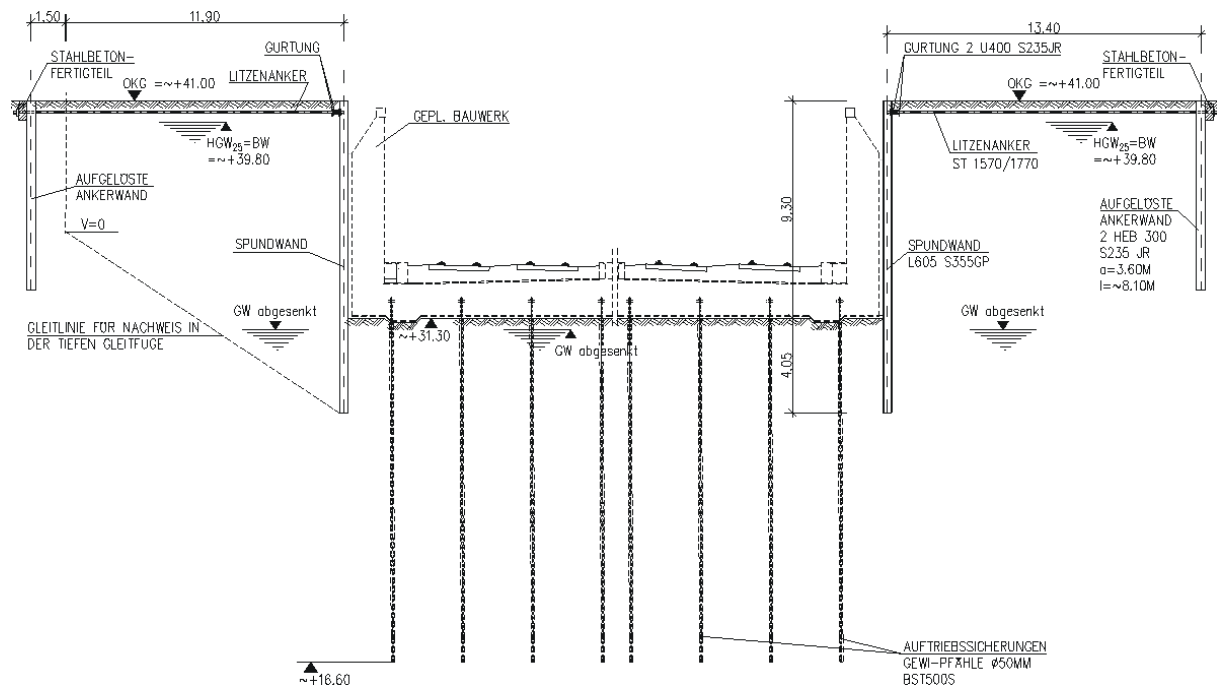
Baugrubenkonstruktion Typ 2 mit Grundwasserabsenkung
